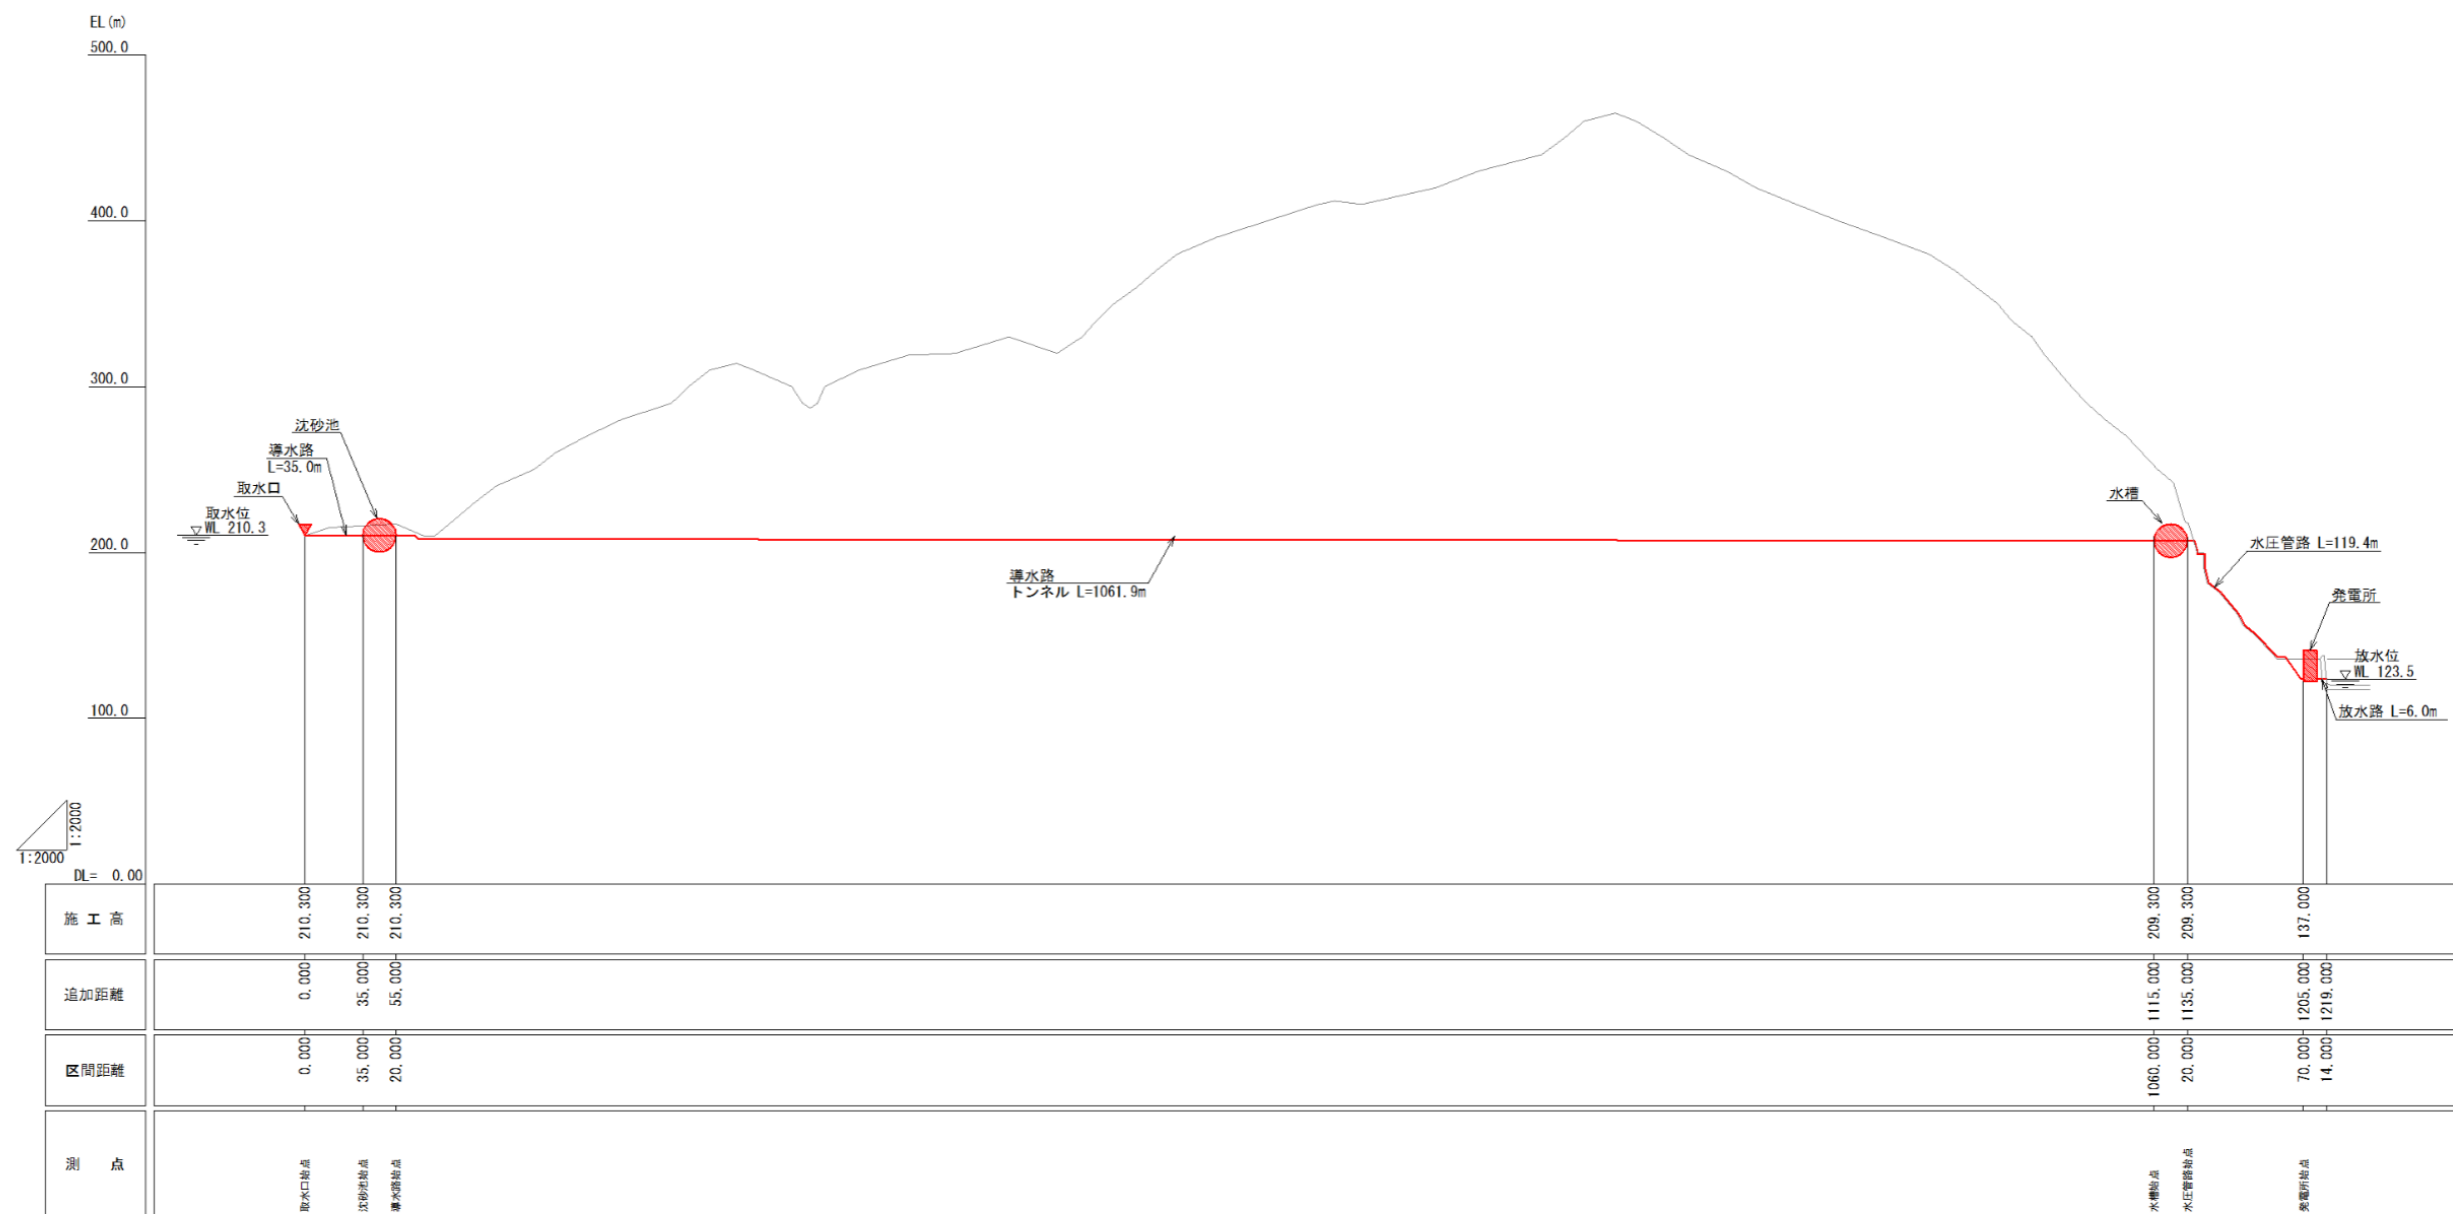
水路縦断面図 (猪野々地点) NO-SCALE
